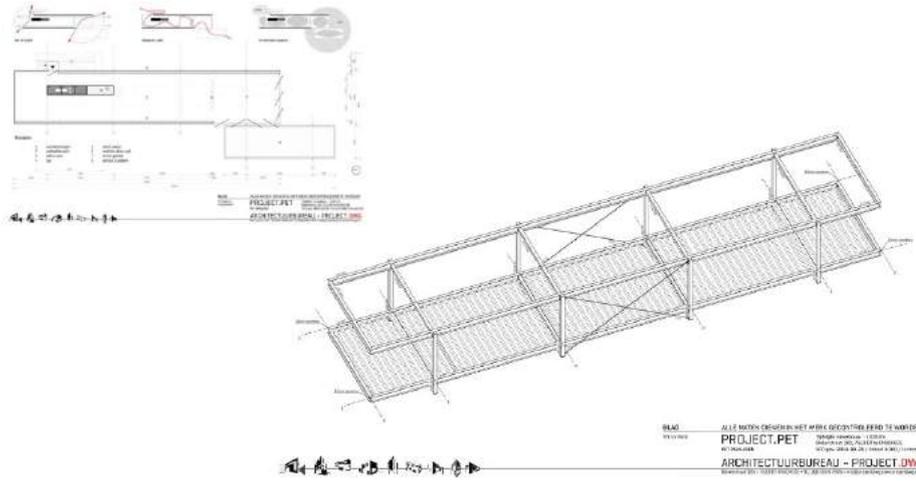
Axonometria Pet Pavilion (Archdaily, 2014)
